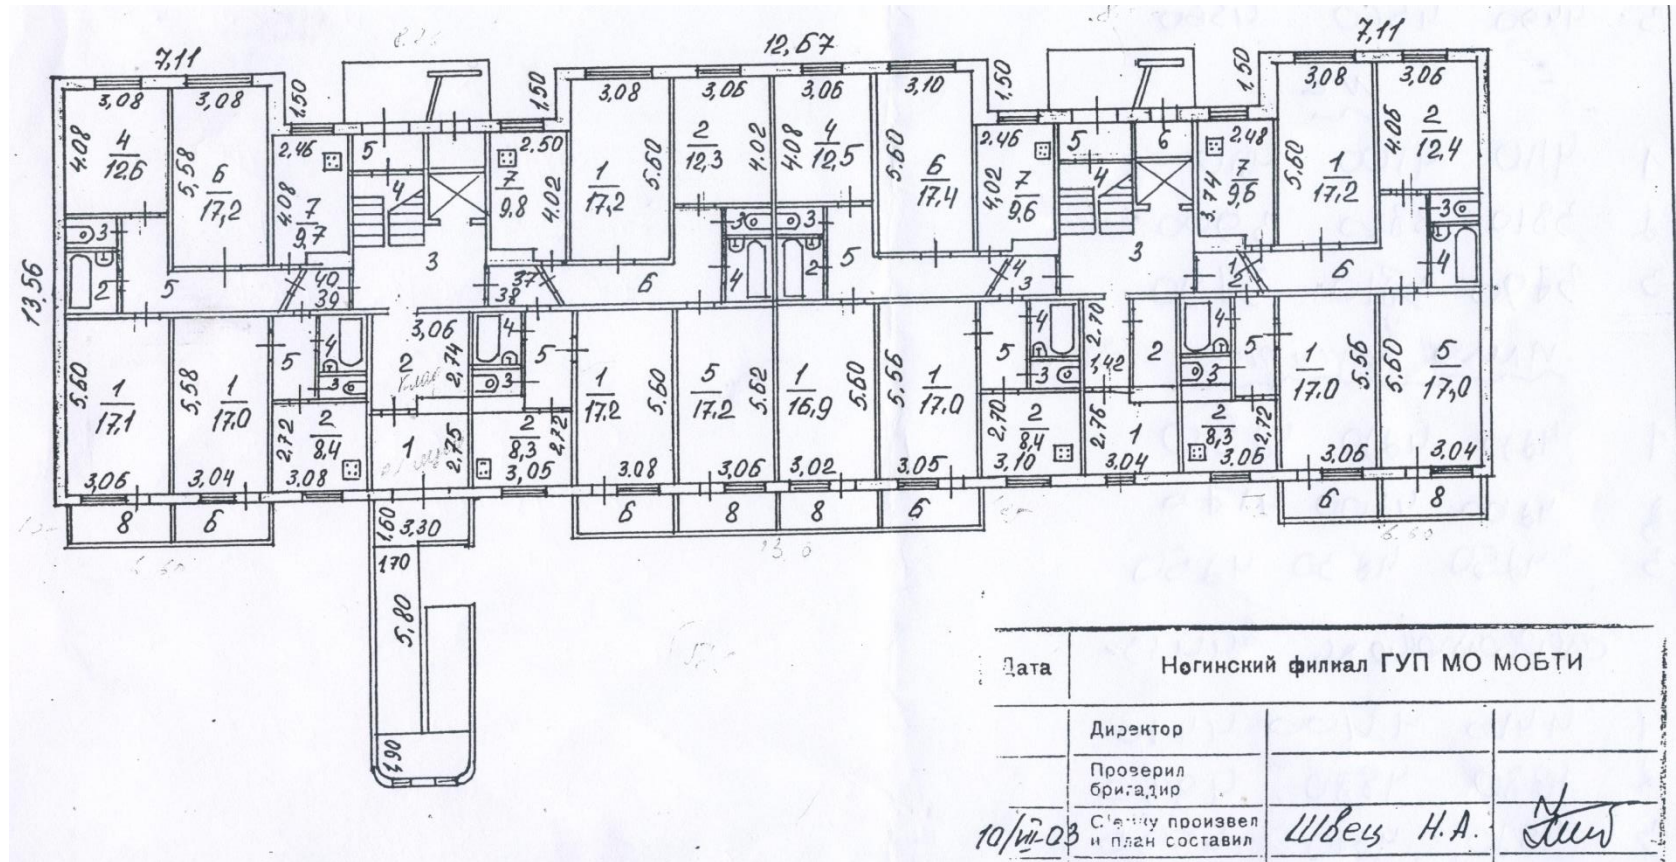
План 1 этажа здания в осях А-Г/1-6
